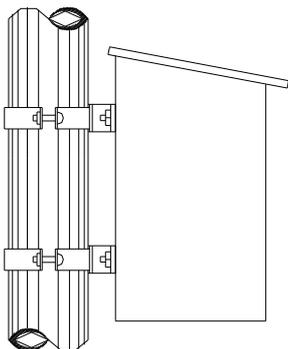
ANCORAGEM DO RAMAL DE LIGAÇÃO
